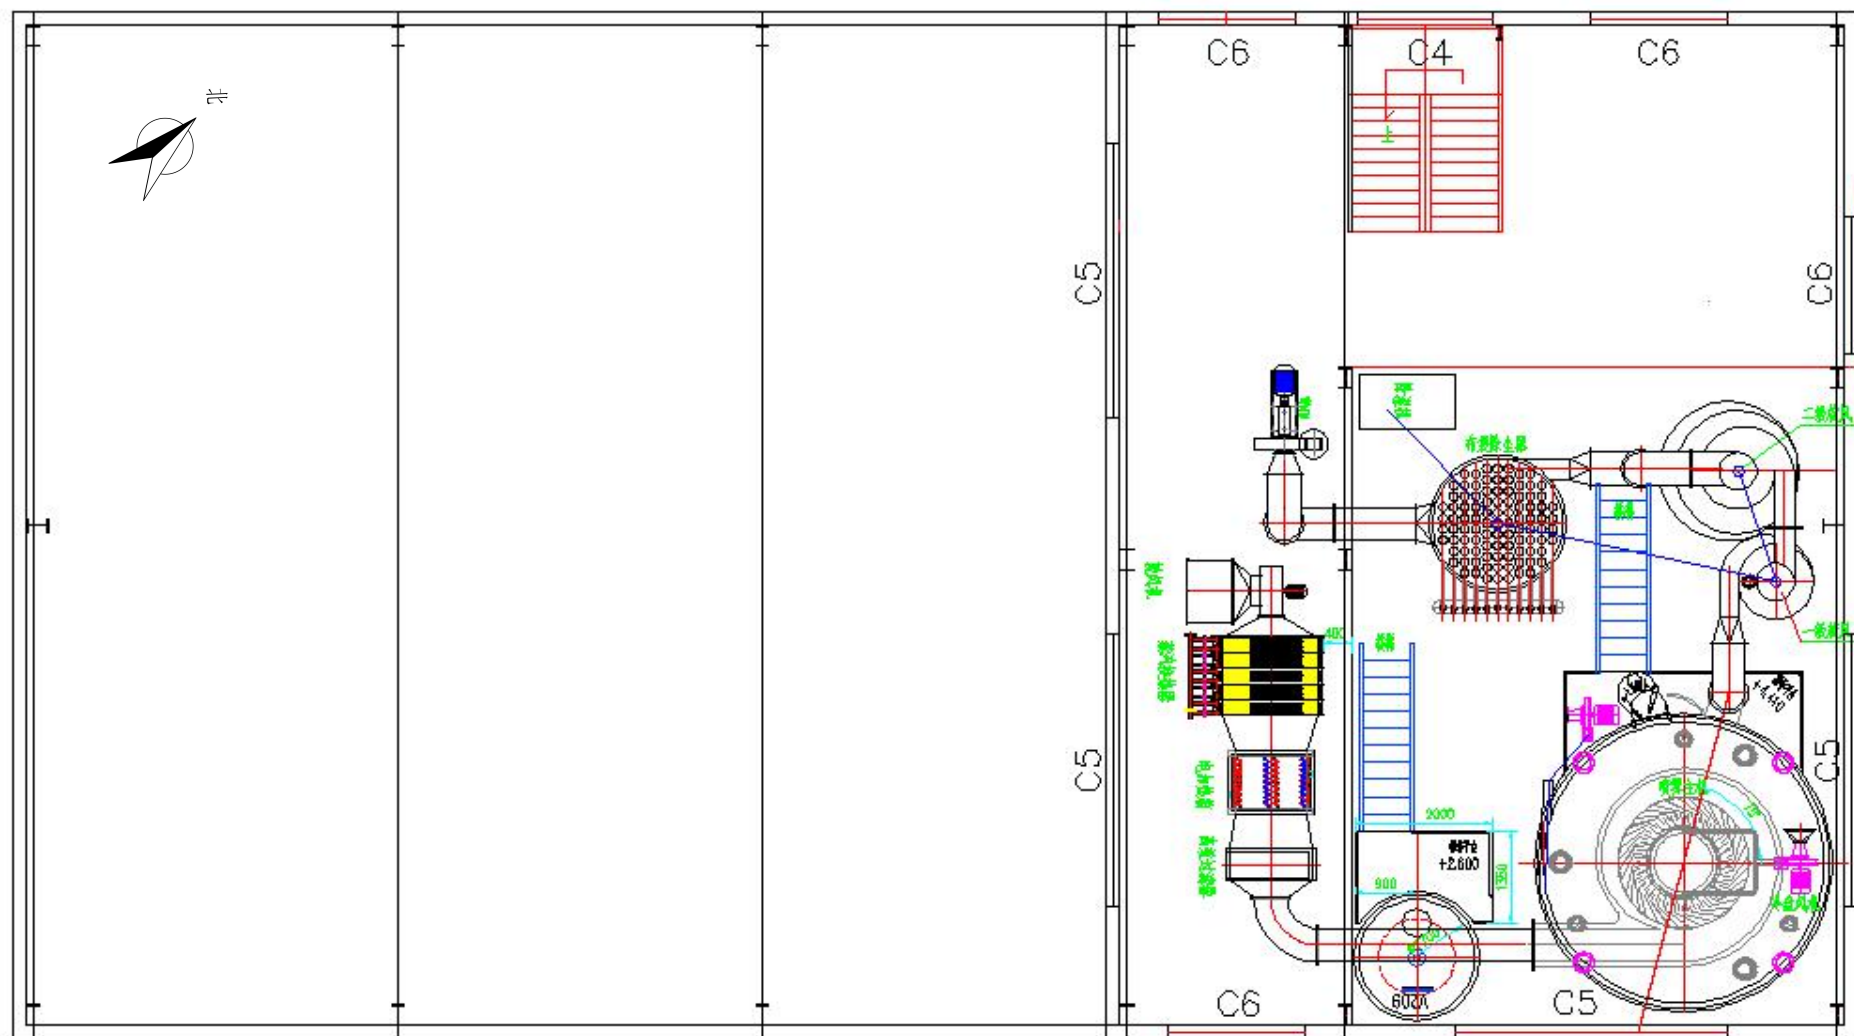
3#3 层喷雾干燥车间平面布局图（示意）
